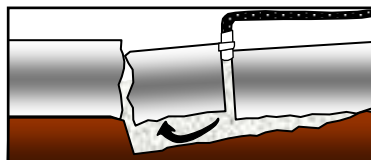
Injection de coulis de ciment permettant de repositionner les dalles
